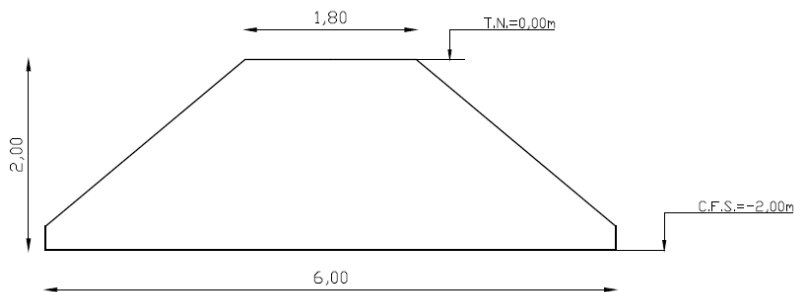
Vista en corte zapata de hormigón armado
